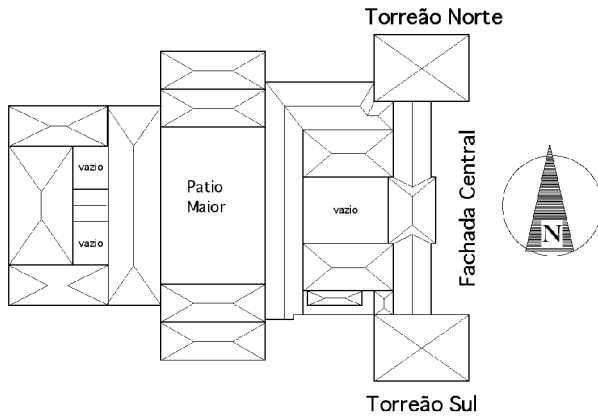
Croqui do Palácio da Quinta da Boa Vista, com indicativo do norte (não exato), e localização dos corpos do Torreão Norte, Fachada Central e Torreão Sul
